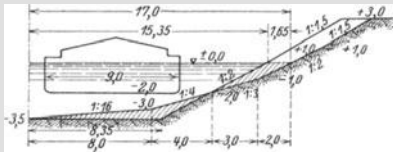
Vergleich zwischen Mulde und Trapez. Maßstab 1 : 500.
